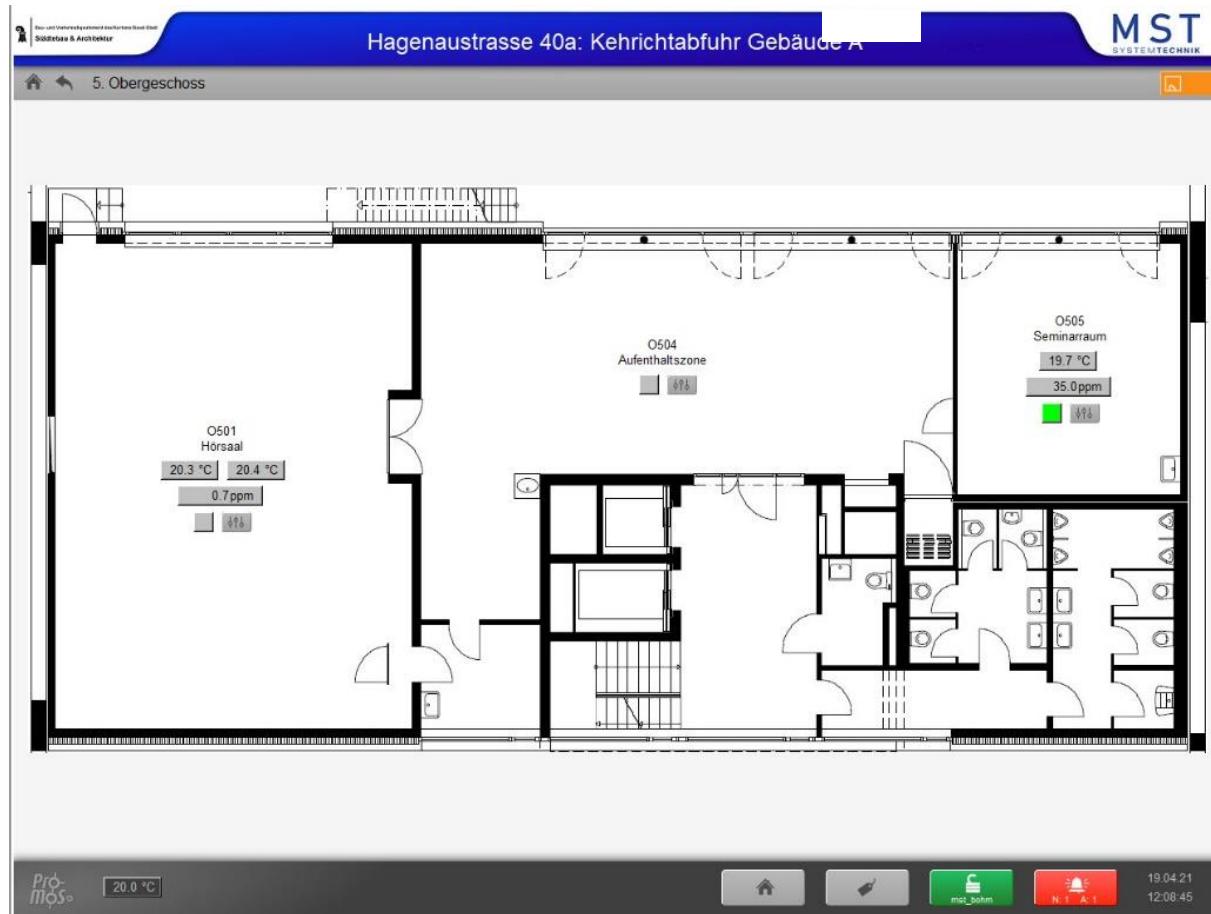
Beispiel Grundriss Raumautomation
